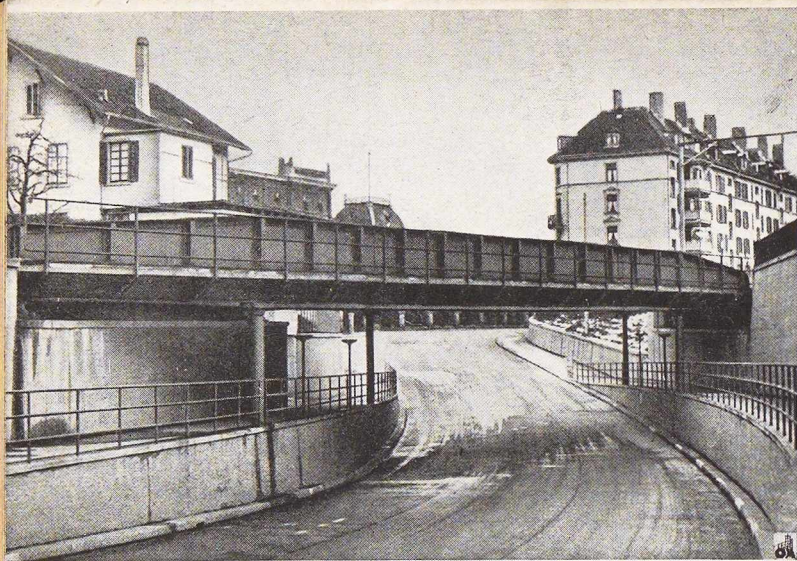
Maîtresses-poutres du pont-rails courbe de Wollishofen.
